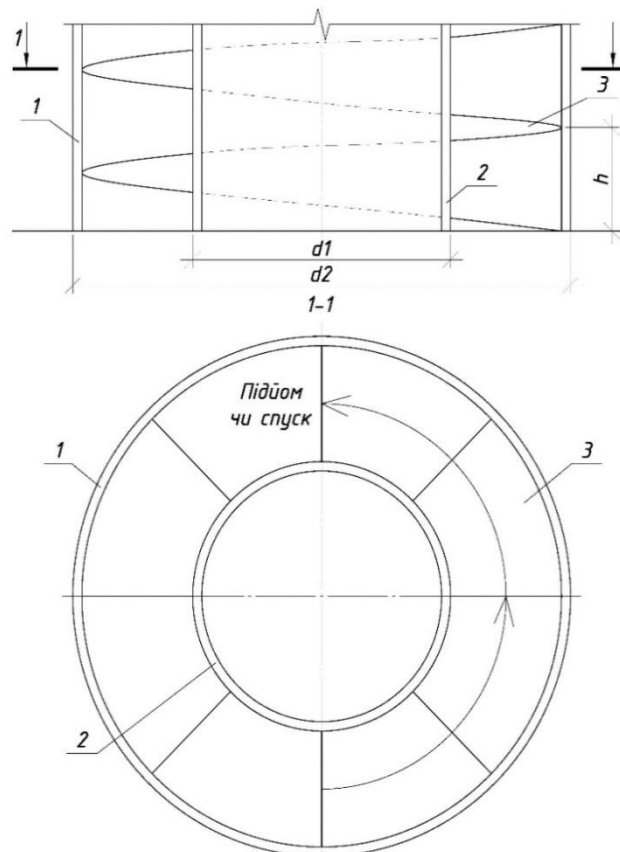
Схема кругової рампи: 1 – зовнішня стіна; 2 – внутрішня стіна; 3 – перекриття у вигляді нахилених поверхонь
